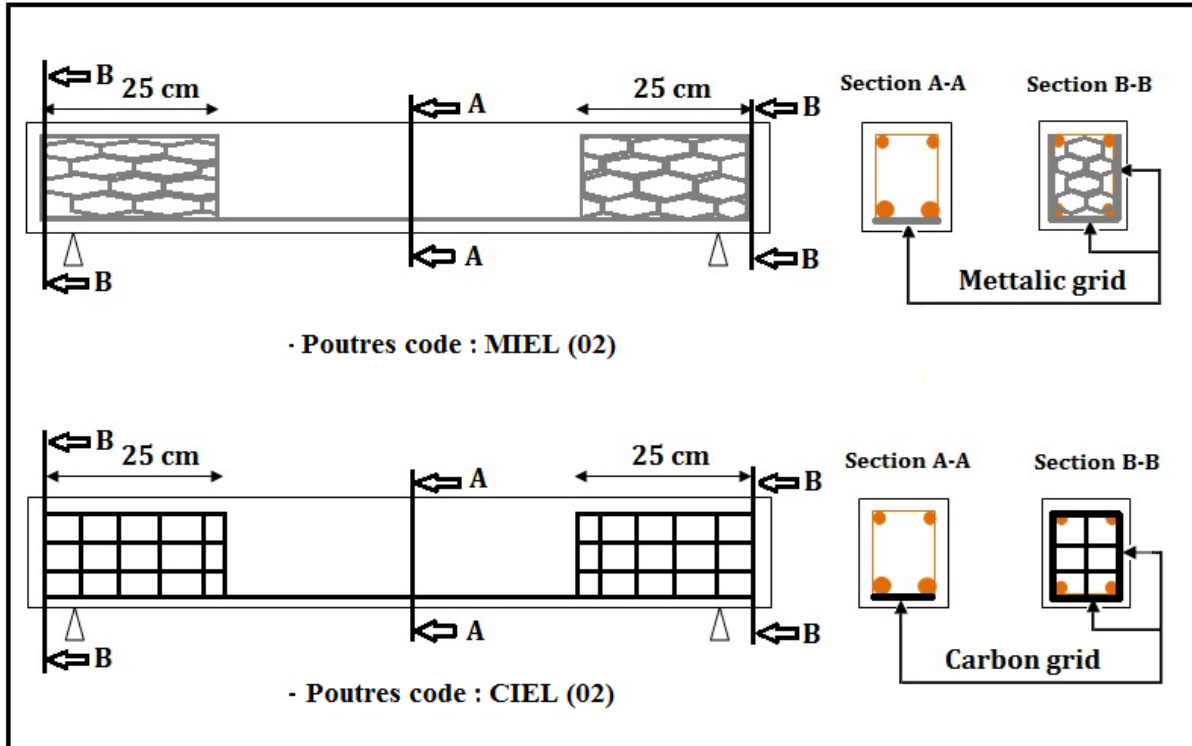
b : Détails de renforcement des poutres du groupe 02.
